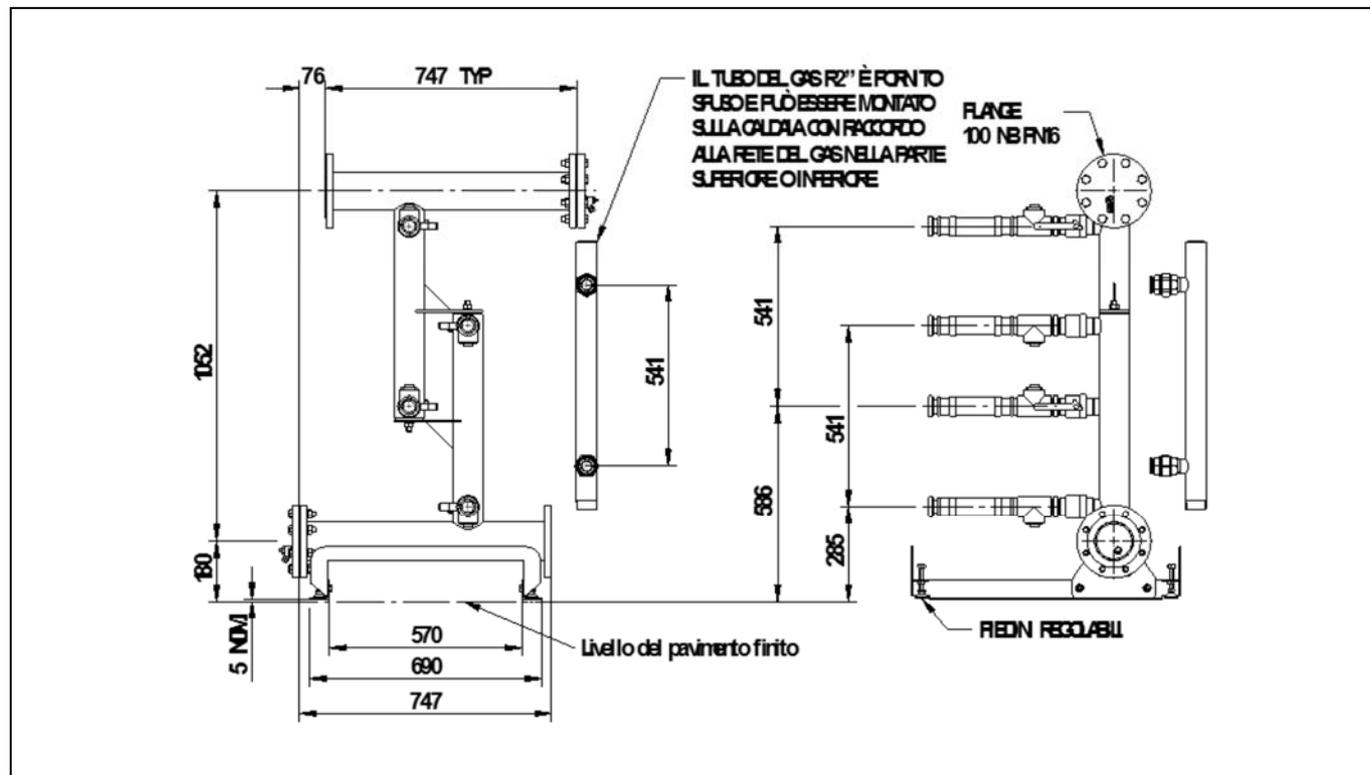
Dimensioni collettore Ygnis Varblok 100/200 e 114/228
